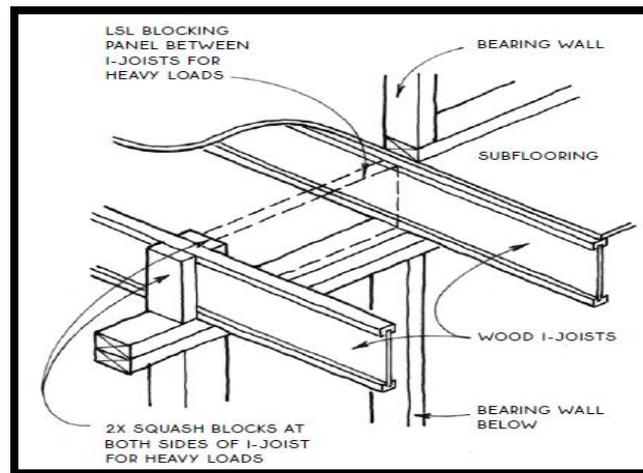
Detalle Blocking. Fuente: Frame Construction.
